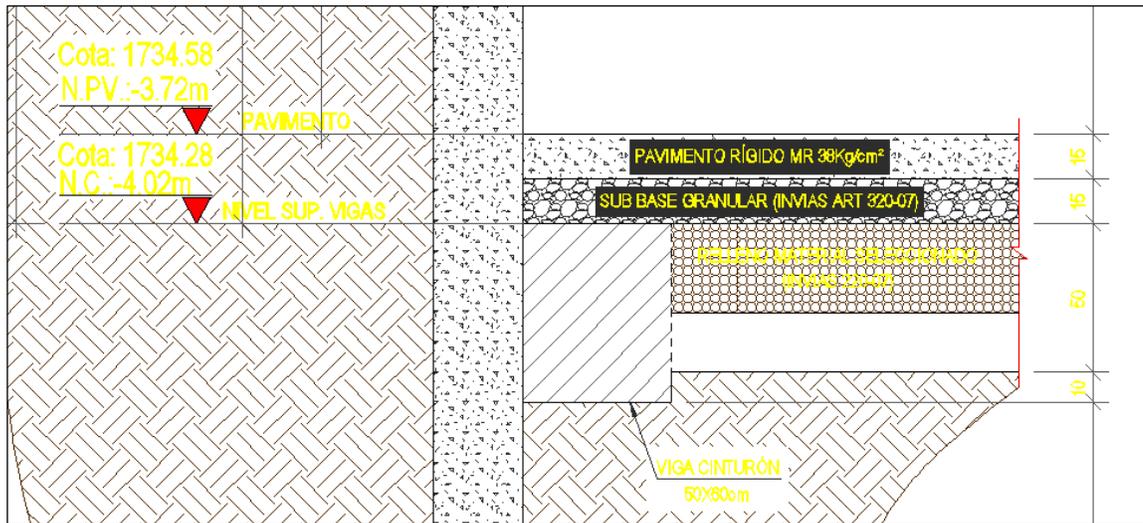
Componentes estructurales del pavimento. Fuente: Fotografía propia.
